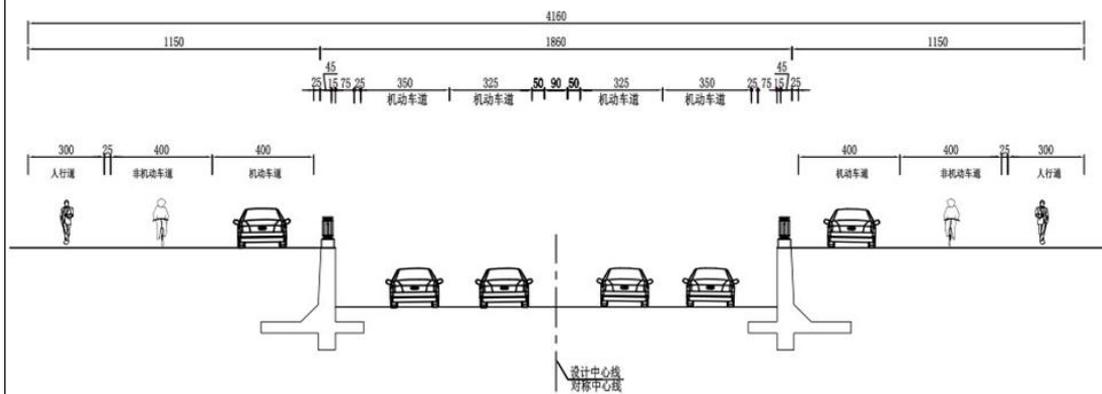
大天路下穿挡墙段横断面布置图 (41.6m)
